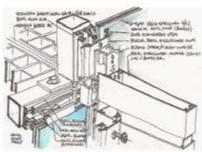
Diseño de fachadas universales Fuente: Xavier Ferres Padro
